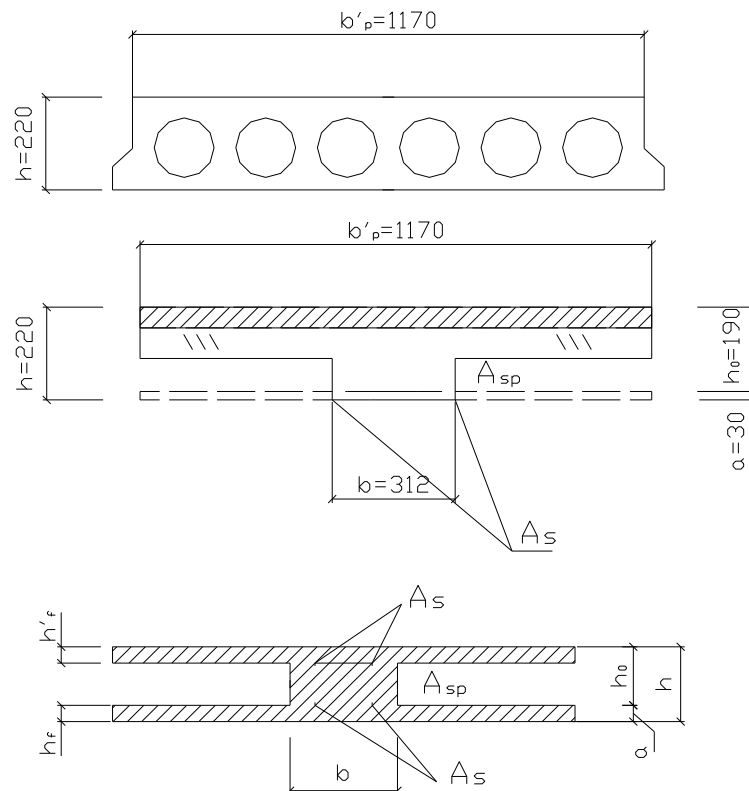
Розрахункова схема та розрахункове січення плити перекриття
